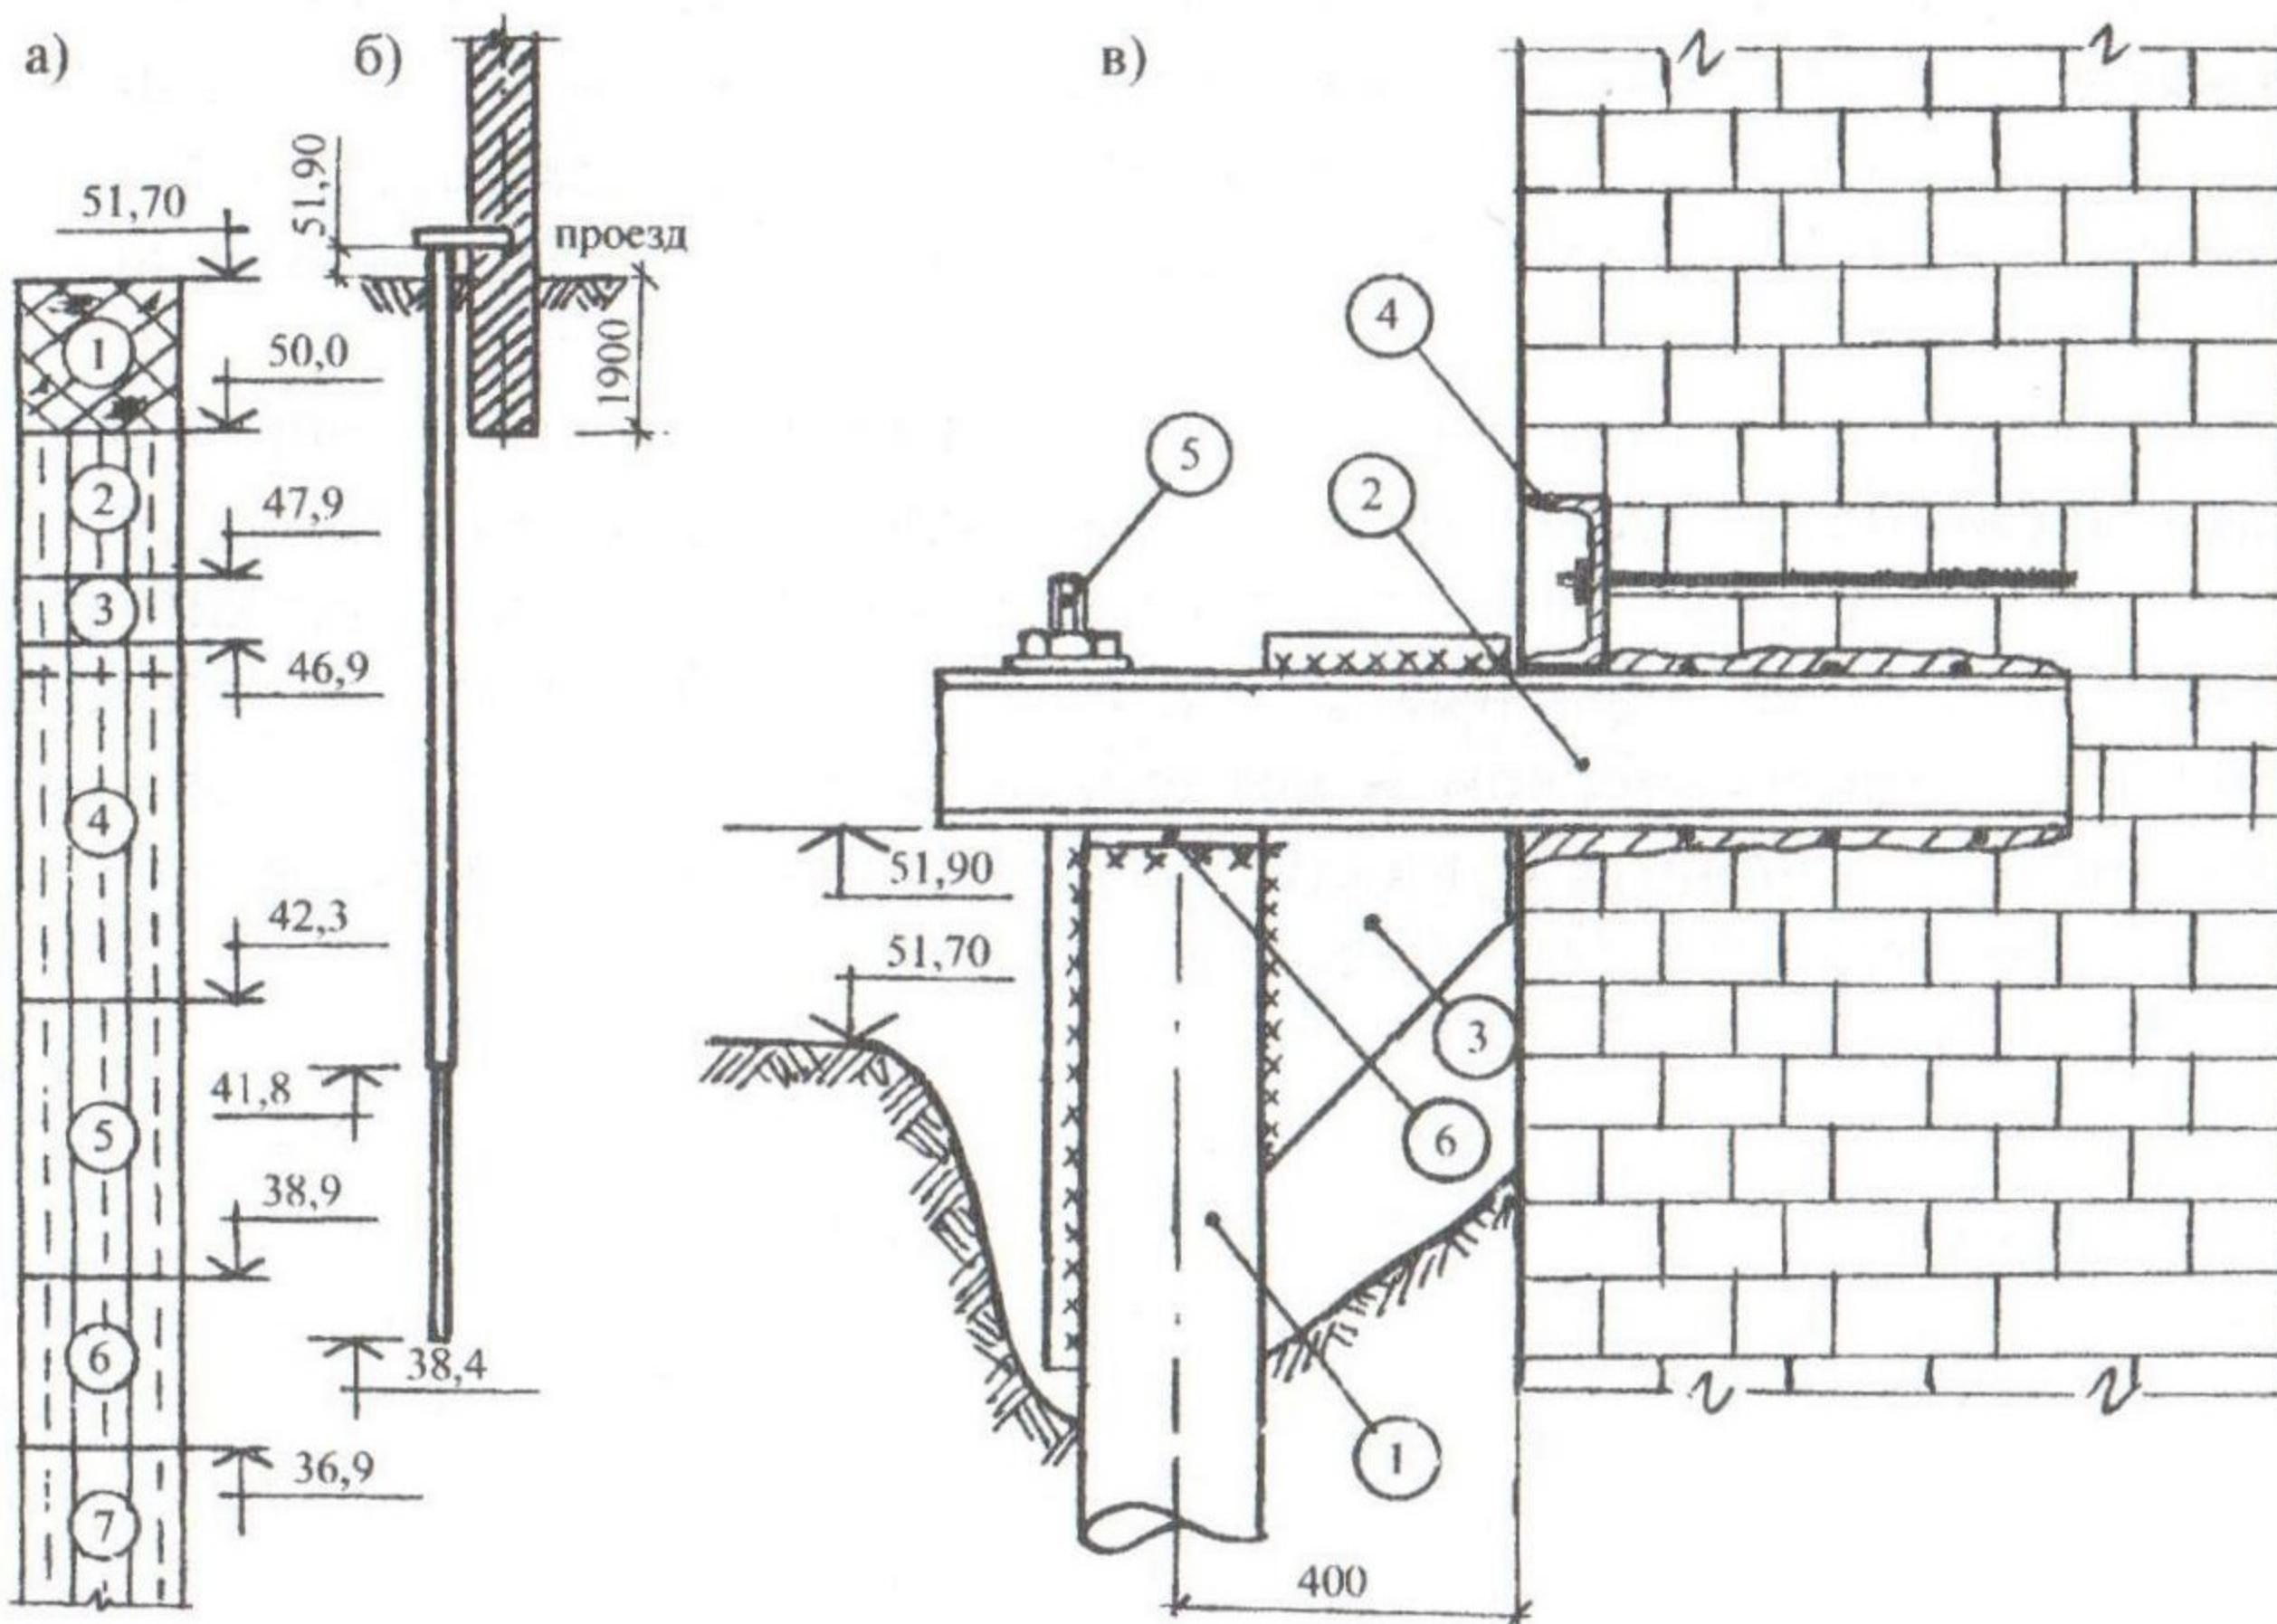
Геологическая колонка (а), схема "разгрузки" торцевой стены существующего здания буроинъекционными сваями (б) и конструкции опорного узла (в).
